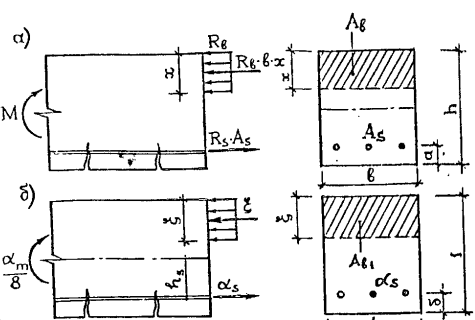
Схема усилий и эпюры напряжений для изгибаемого железобетонного элемента прямоугольного сечения: а) в абсолютных значениях; б) в относительных величинах
